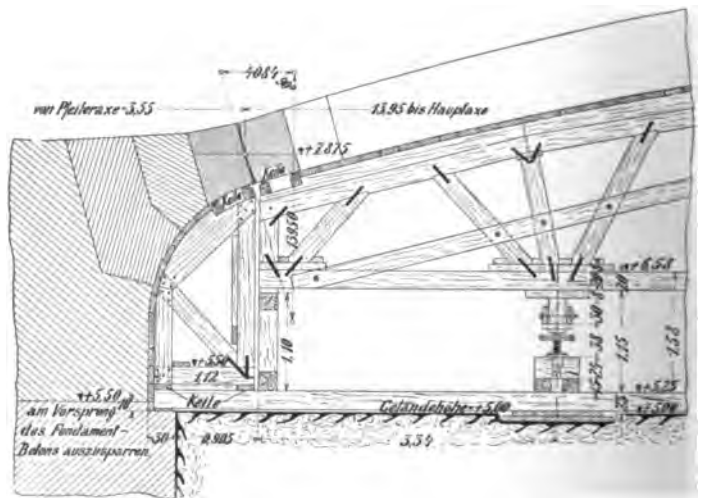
Lehrgerüst der Ausstellungsbrücke in Düsseldorf.
